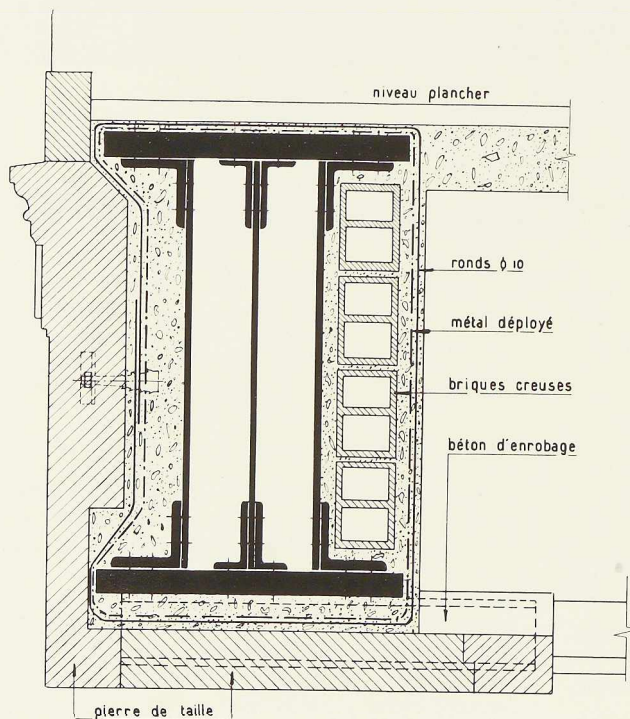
Détail d'enrobage des poutres en façade au niveau du premier étage. Coupe au droit des balcons.
